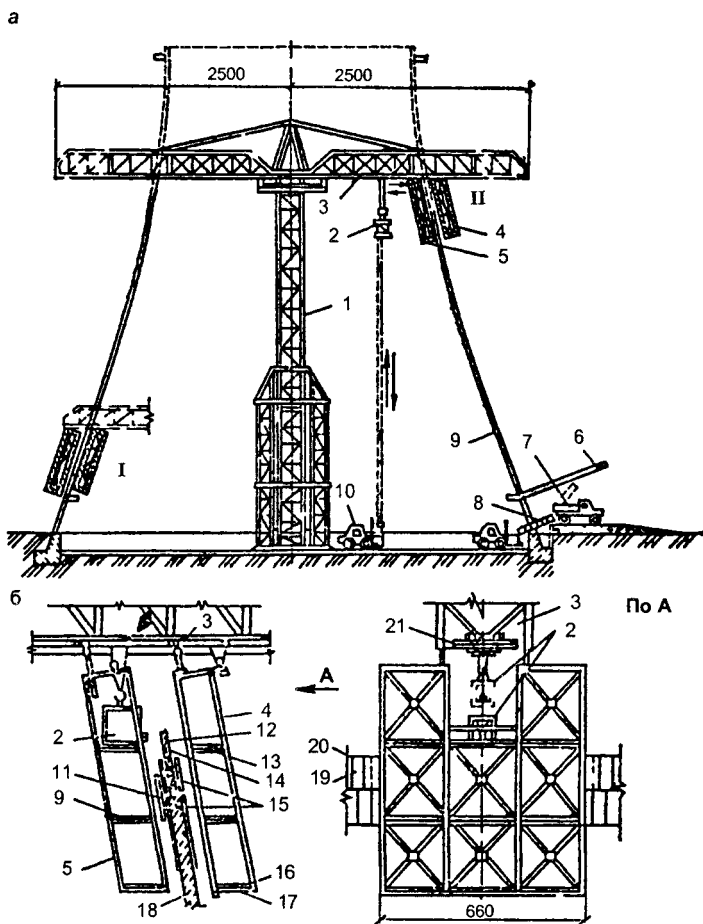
Схема бетонирования оболочки градирен с применением двухконсольного крана:
